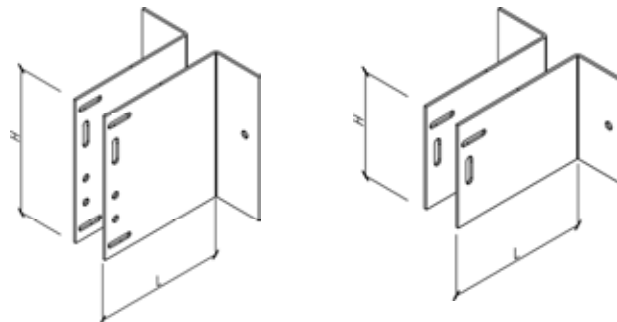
Elementy NOVABRIK: a) parapet, b) element wykończeniowy
